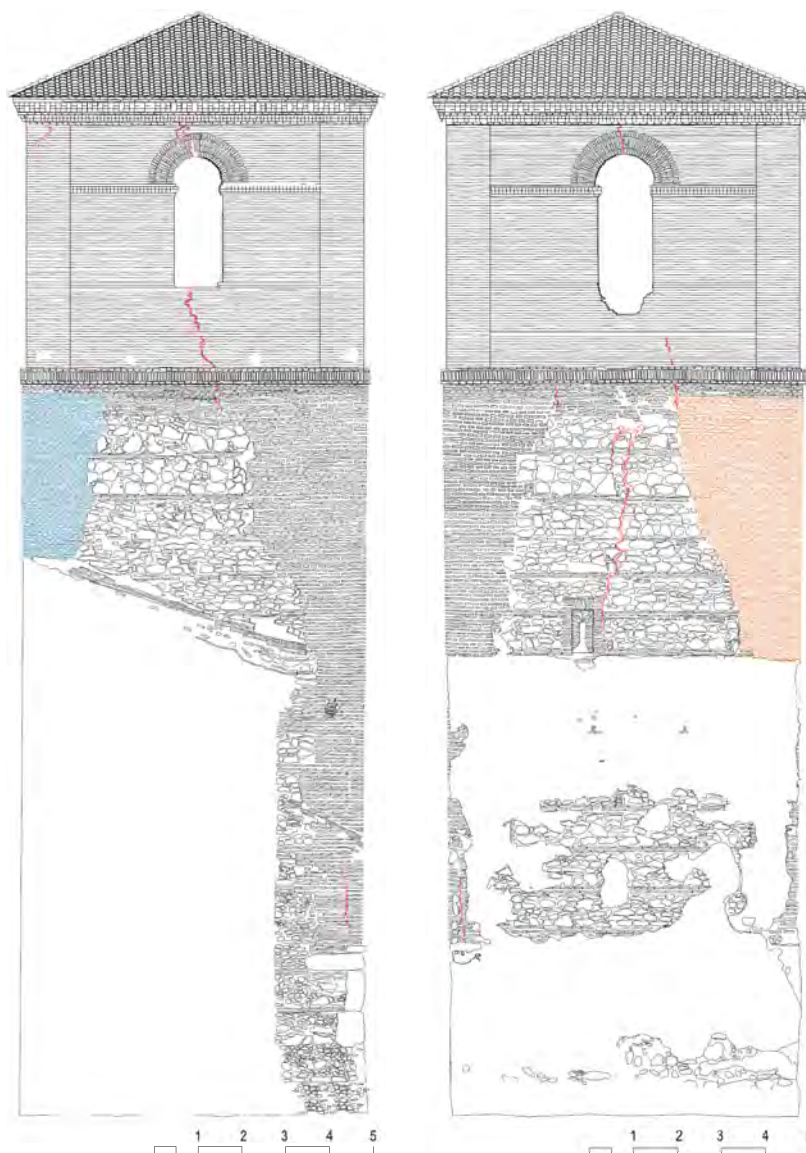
alzados oeste y sur de la torre en los que se señalan en rojo las grietas principales que afectan a la torre. En el oeste, se aprecia la grieta junto a la cornisa, que amenaza desprendimiento y la caída de algunas piezas en las roscas del arco. La grieta progresa debajo del hueco de campanas y avanza por la parte alta del fuste de la torre. Se señala en azul la fábrica de refuerzo que probablemente se acometiera en el año 1838.
